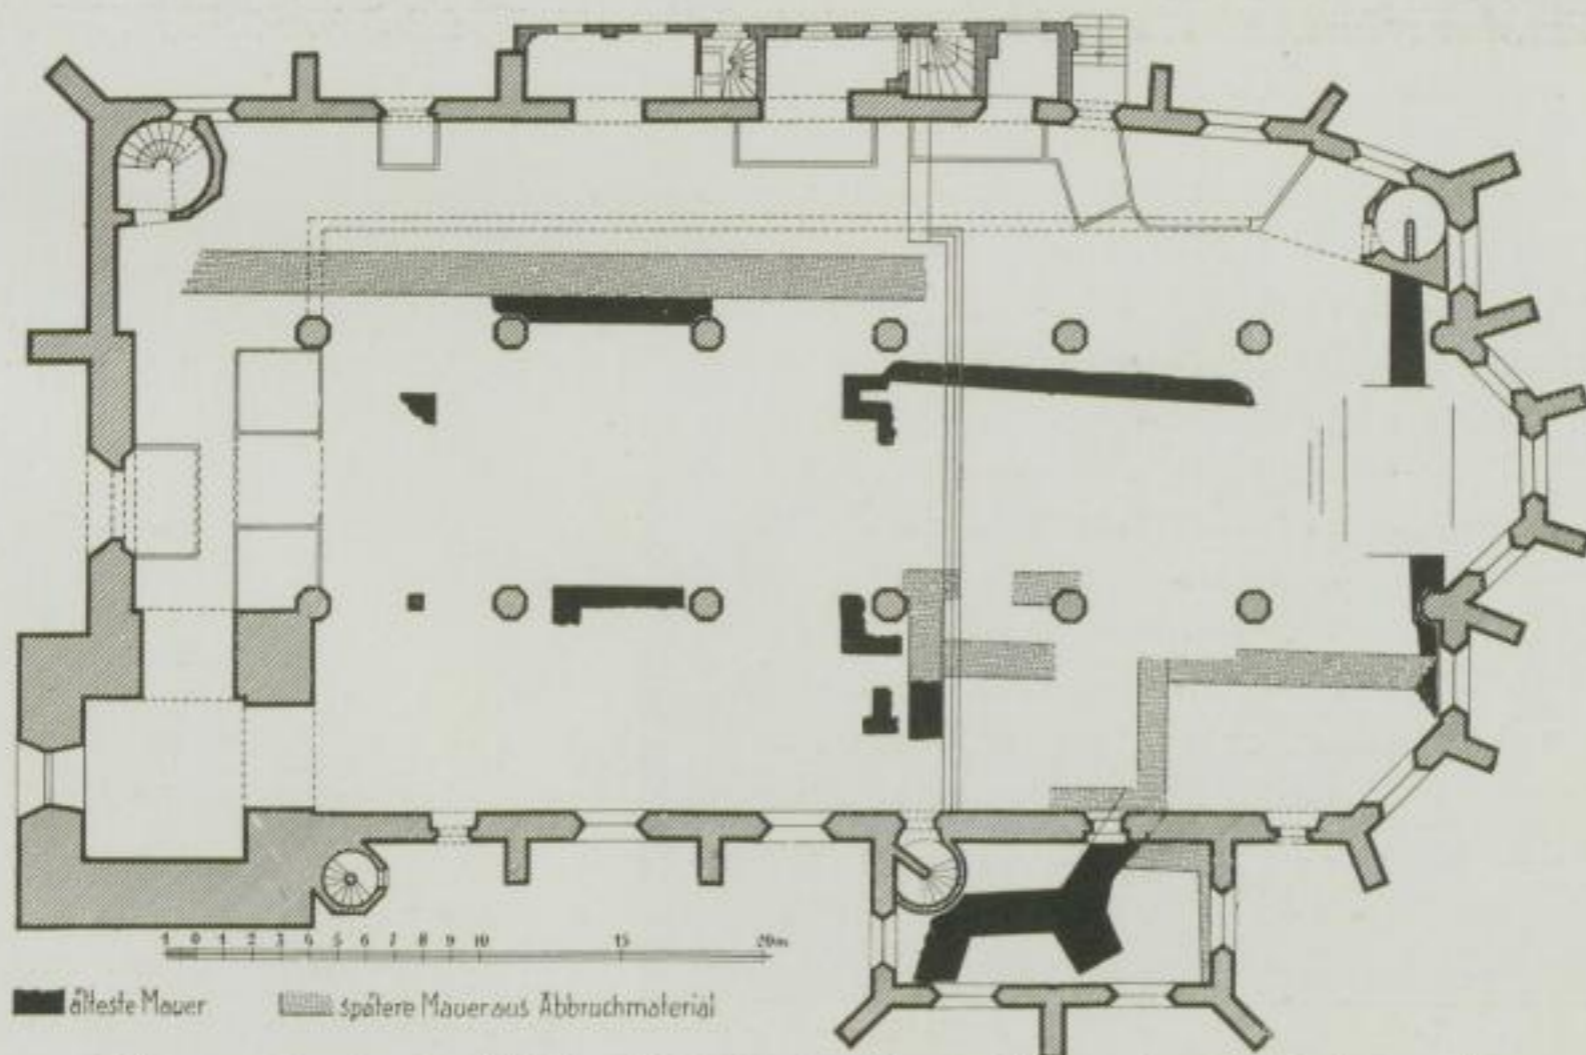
Plan der Stadtkirche mit Resten der älteren Kirchenanlagen. (Nach Quentin)
